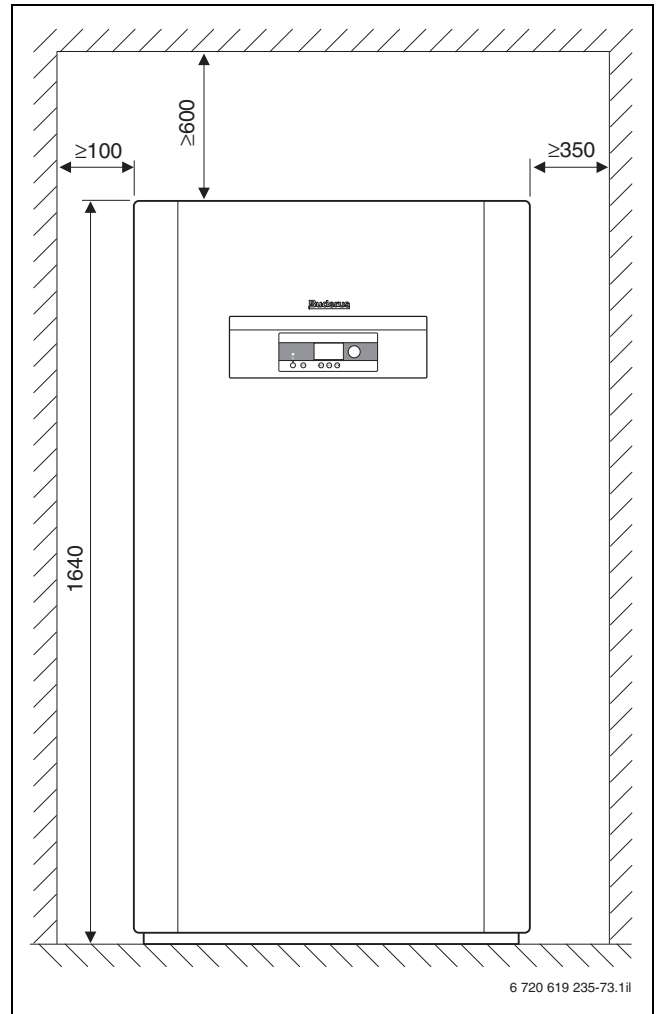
Mindestabstände der Wärmepumpen Logatherm WPS 43 - 60 (Maße in mm)
